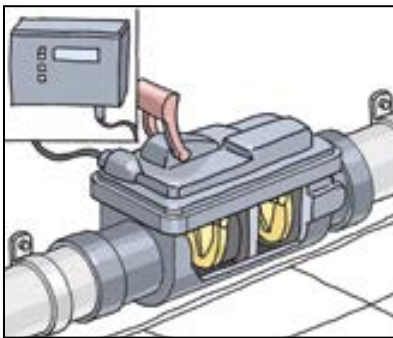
Elektronisch gesteuerter Rückstauverschluss – erforderlich bei fäkalienhaltigem Abwasser.
